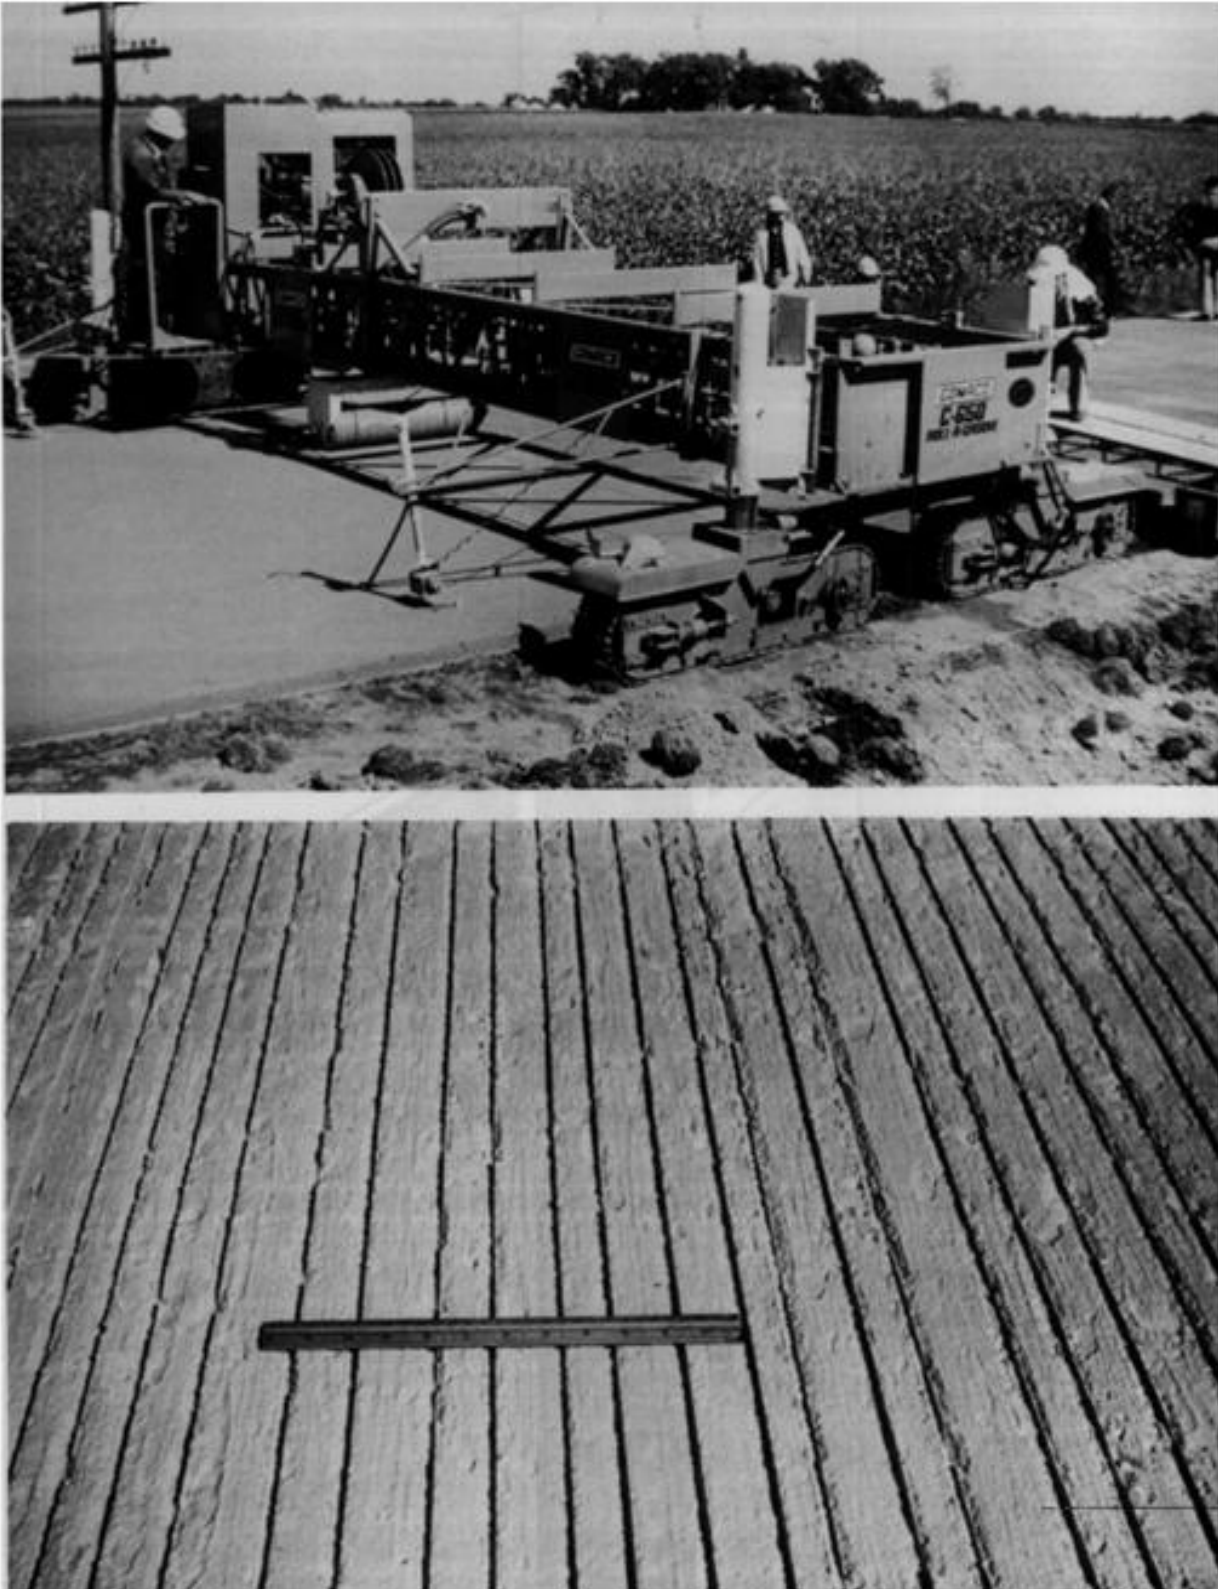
Rãnh xẻ trên mặt đường BTXM (sawed grooves in PCC pavement)
